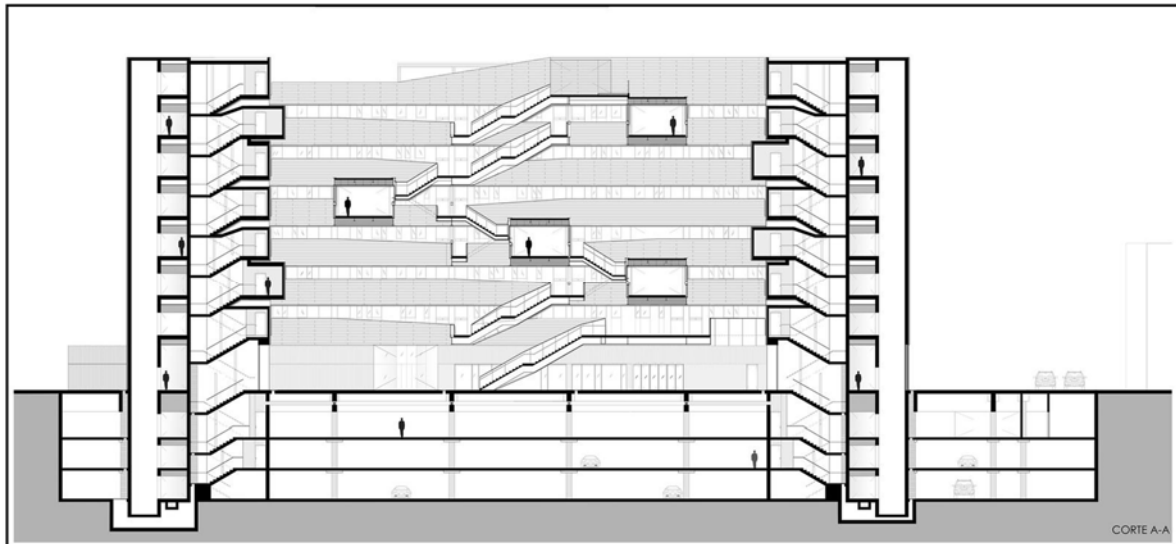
Corte A-A del Pabellón A (Ingeniería). (Fuente: Archdaily.pe)
